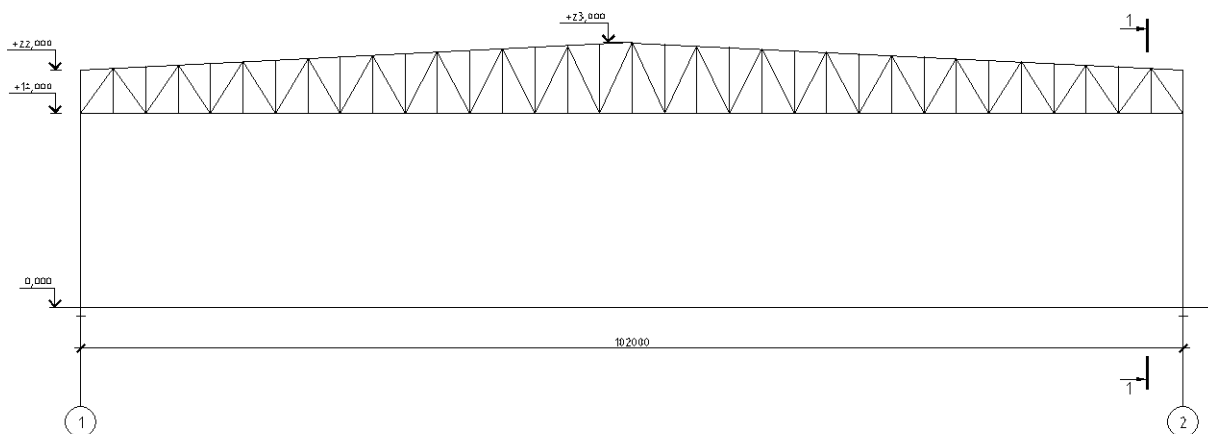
Вариант с балочным покрытием из трапециевидных ферм
